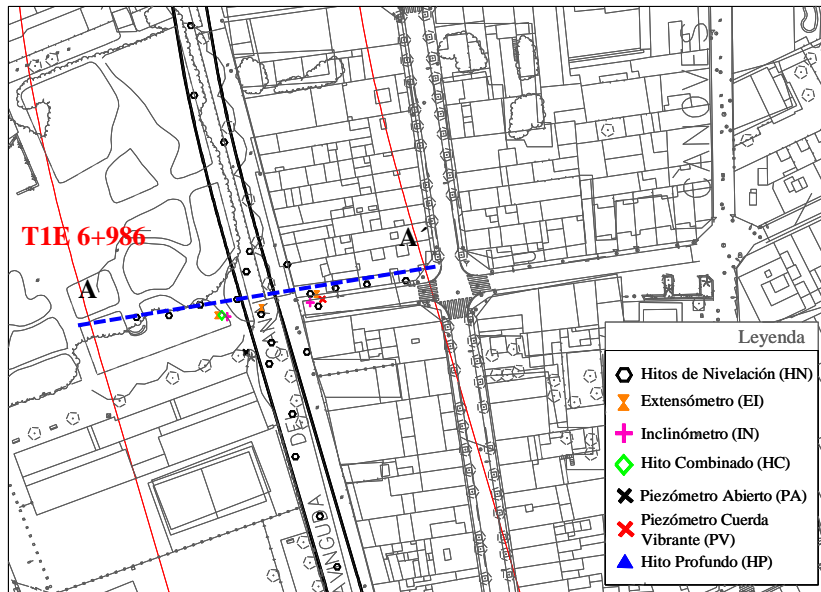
38. Situación en planta del túnel y la sección de control T1E PK 6+986
